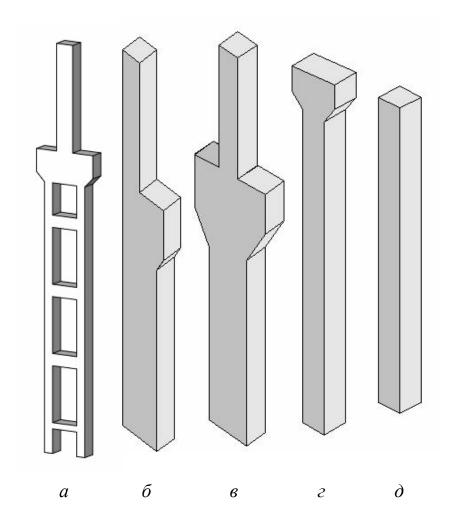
Колонны железобетонные для промышленных зданий: а — двухветвевая колонная средних рядов для зданий с мостовыми кранами; б — колонна сплошного сечения крайнего ряда для зданий с мостовыми кранами; в — колонна сплошного сечения среднего ряда для зданий с мостовыми кранами; г — колонна сплошного сечения среднего ряда для зданий без мостовых кранов; д — фахверковая колонна
